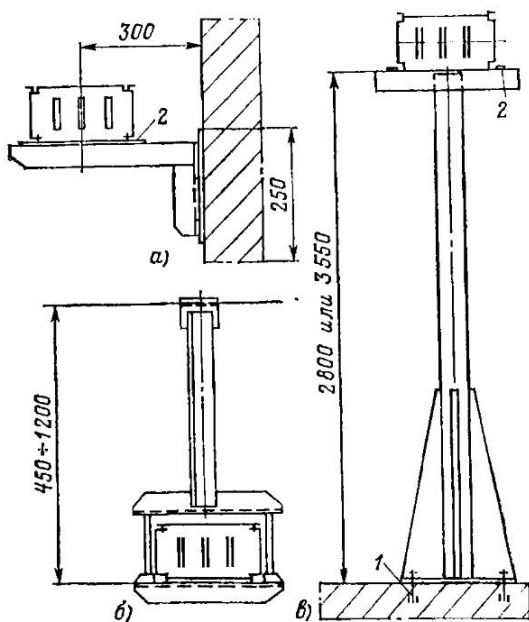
Горизонтальная прокладка магистральных шинопроводов. а — на кронштейнах; б — на подвесах; в — на стойках; 1 — крепление стоек к полу; 2 — крепление секций шинопровода к опорной конструкции.
